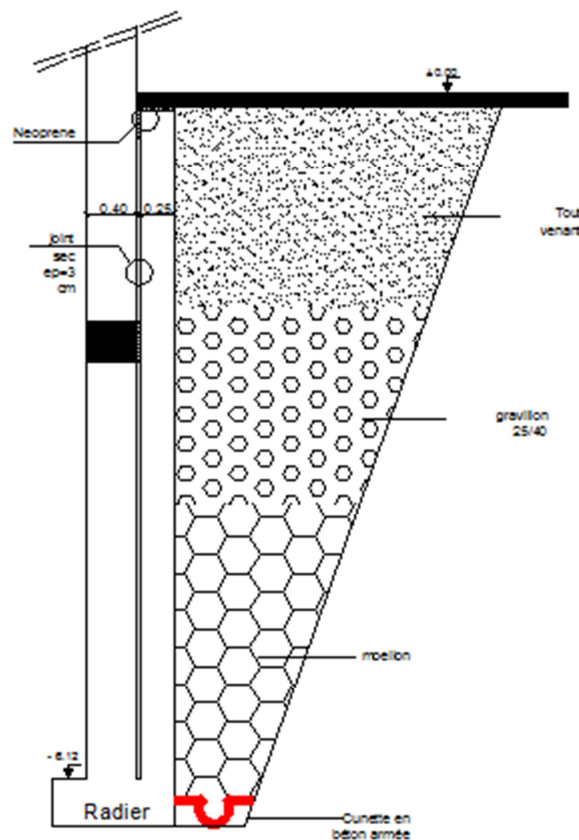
B : Schéma du mur plaque : b)- Vue en élévation
